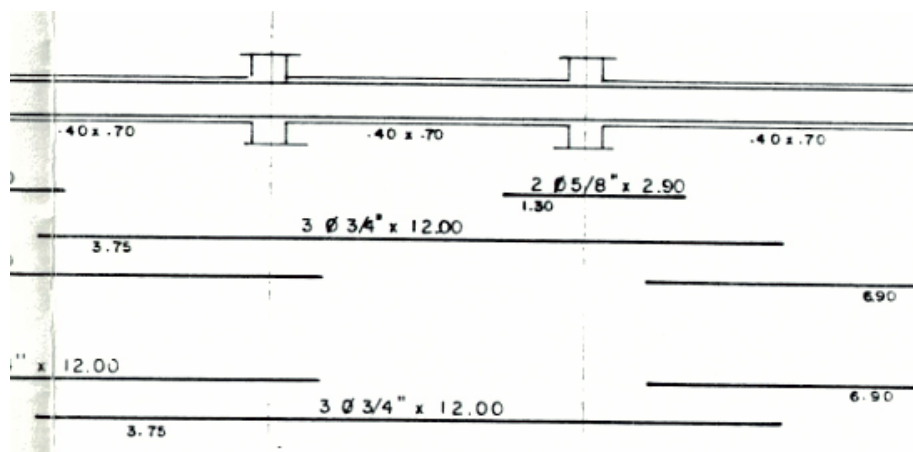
Pórtico D tramos (6'-7) (7-8) Niveles 3, 2,1 y Planta baja
